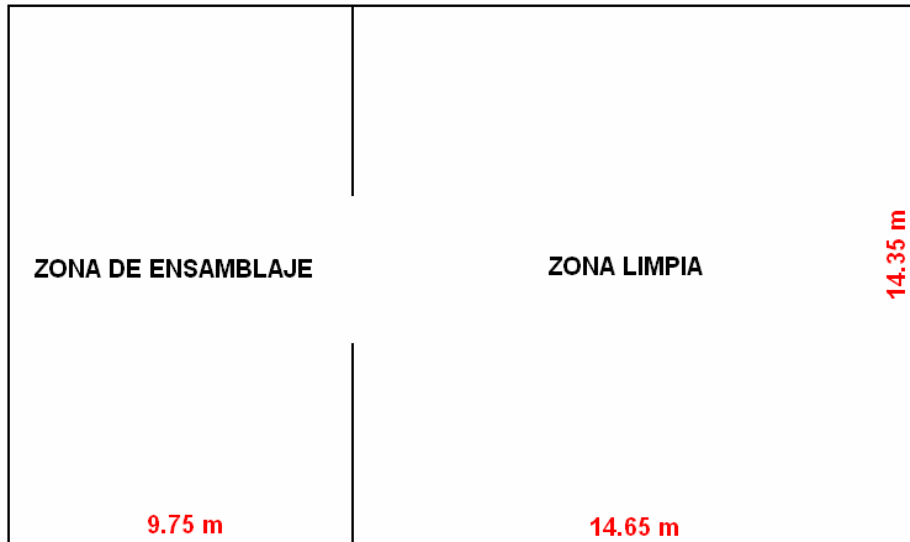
Zonas y dimensiones de la planta de fabricación
